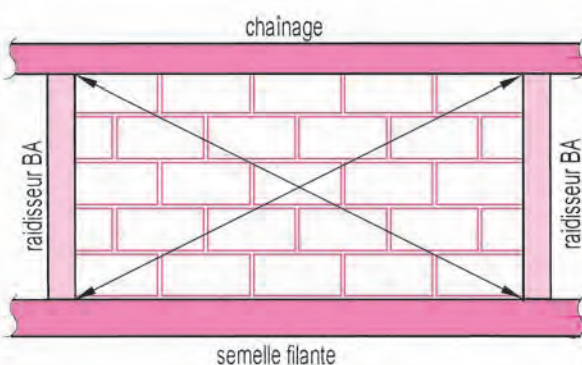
Schéma constructif par semelle filante et mur de soubassement avec raidisseurs en béton armé
